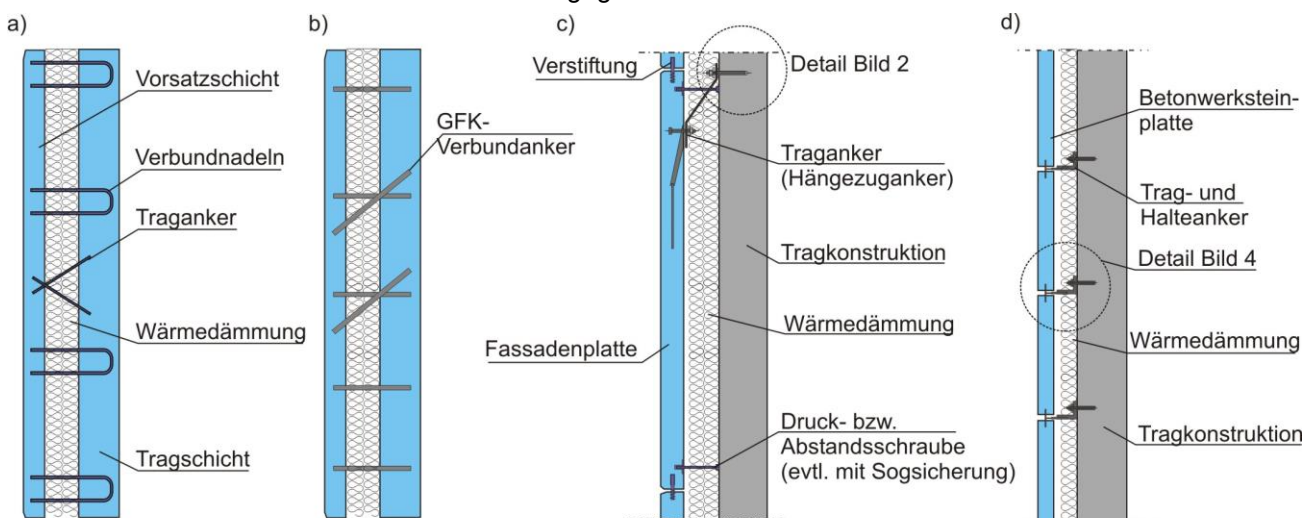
Beispiele für Fassadenausbildungen: a) und b) Sandwichelemente (vgl. 2.1), c) großformatige, vorgehängte Fassadenplatten (vgl. 2.2), d) vorgehängte Betonwerksteinplatten (vgl. 2.3)
